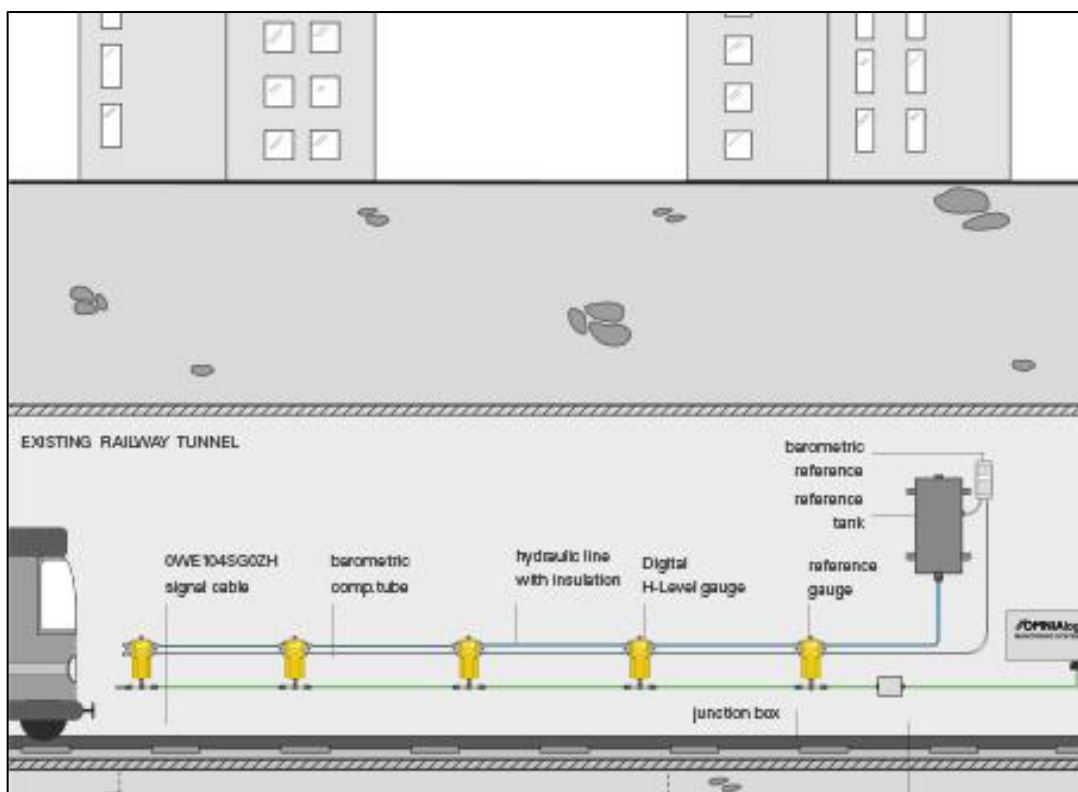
Exemple de tassomètres hydrauliques en tunnel ferroviaire
